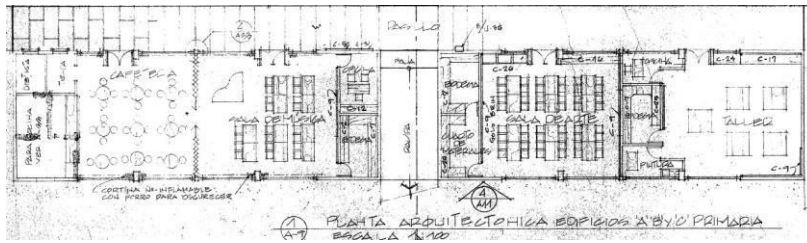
Porción de plano de planta arquitectónica de Edificio C (Ibarra, 1980)
